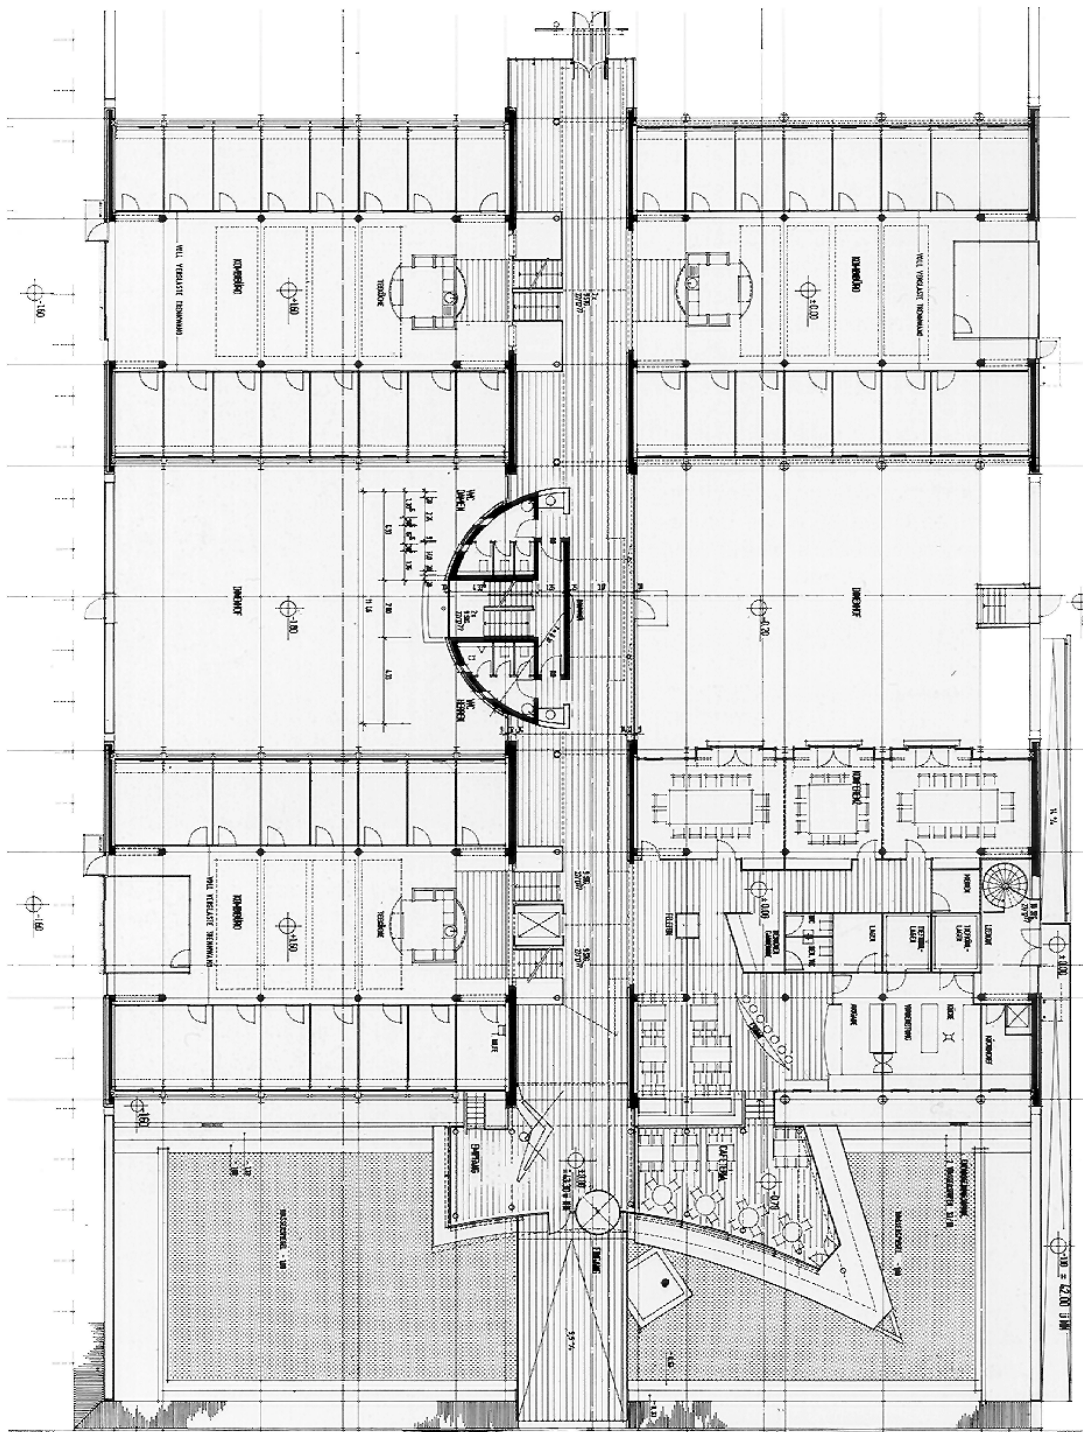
Grundriss Erdgeschoss
